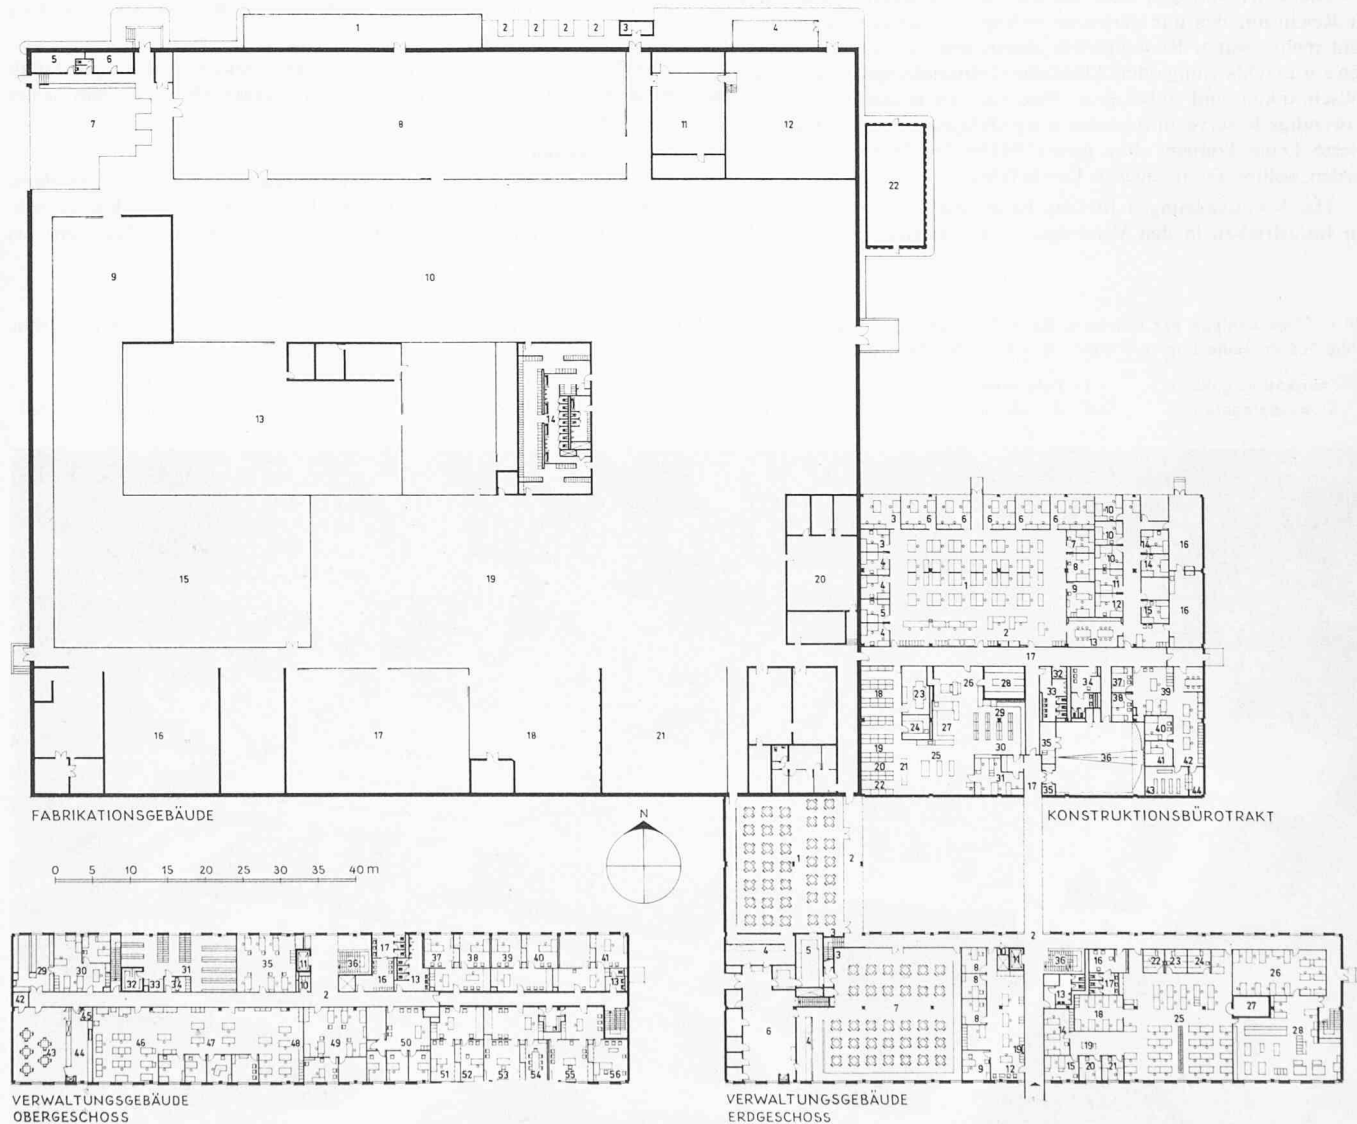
Fabrikanlage der Otis Engineering Corporation, Dallas, Texas. Grundriss 1:1000
